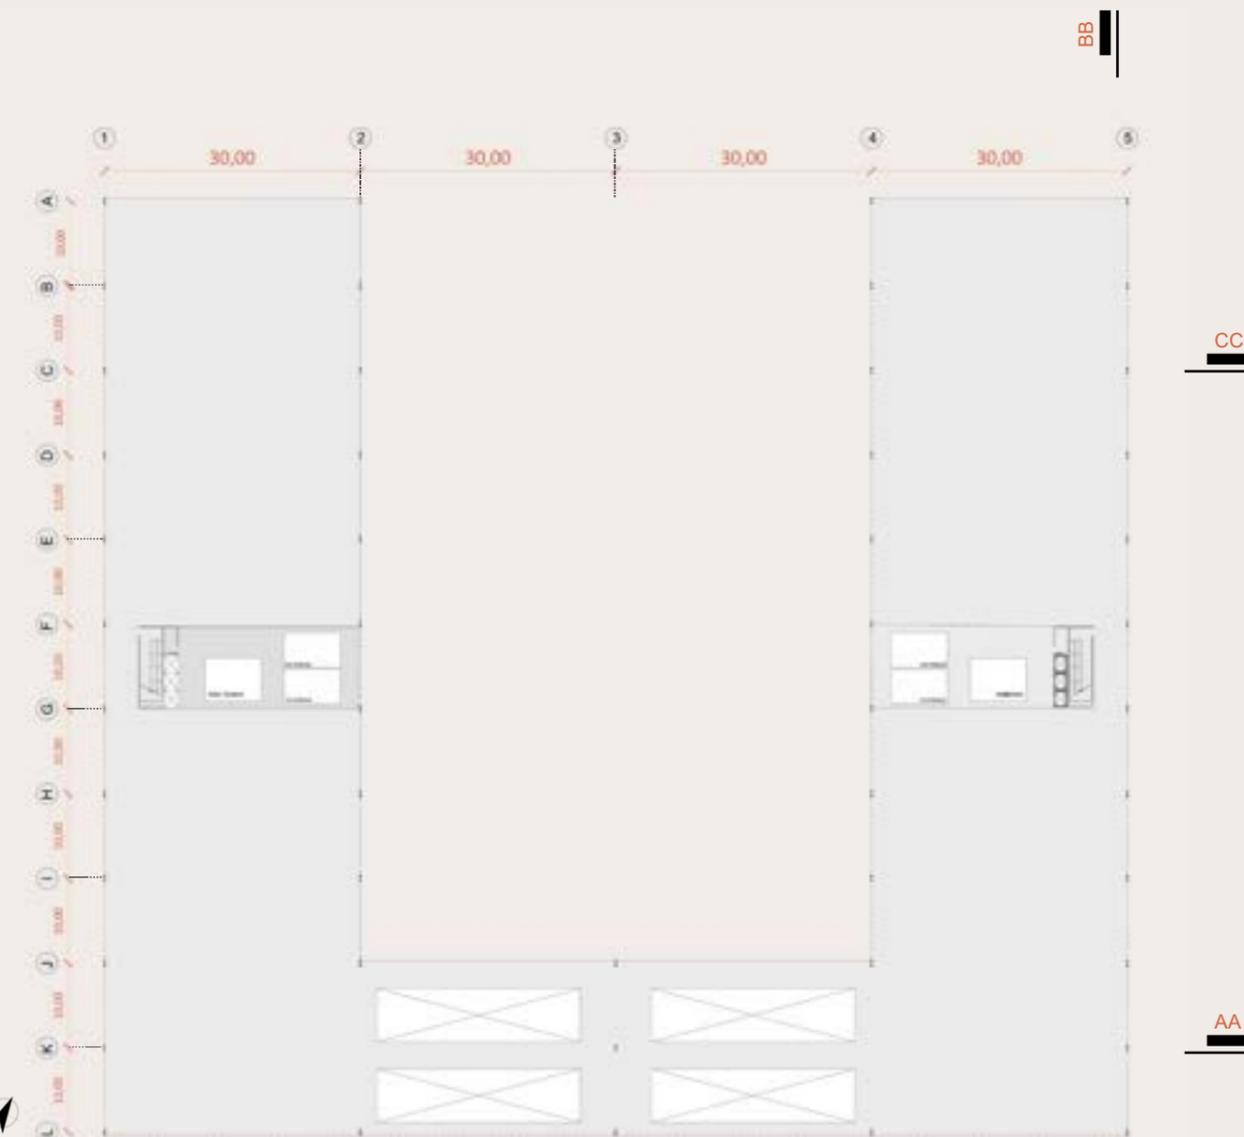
Planta técnica, cobertura. Fonte: autoria própria.
